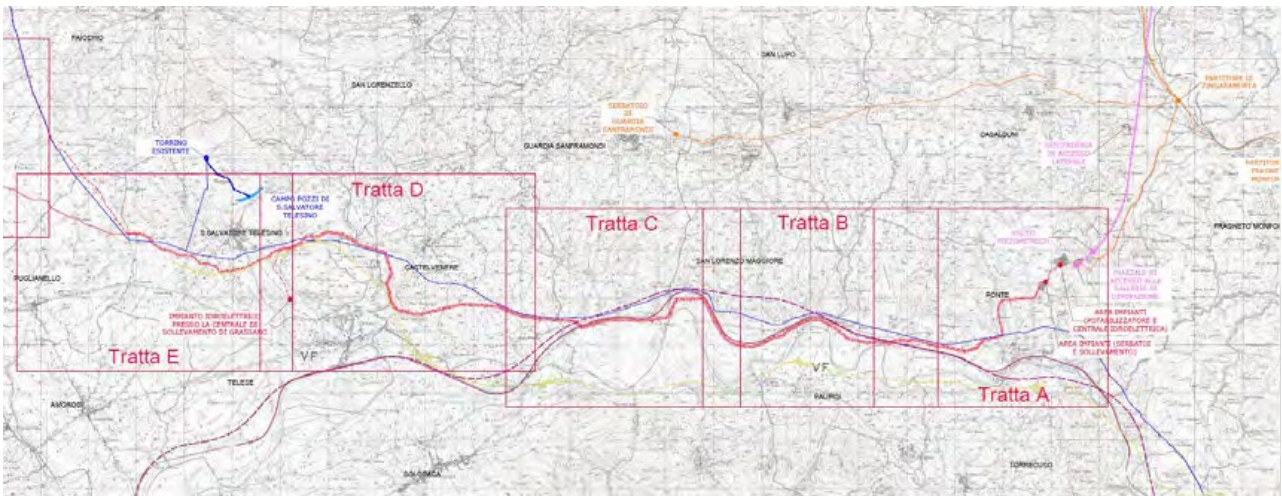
Planimetria della condotta di adduzione ACAM (linea rossa)
